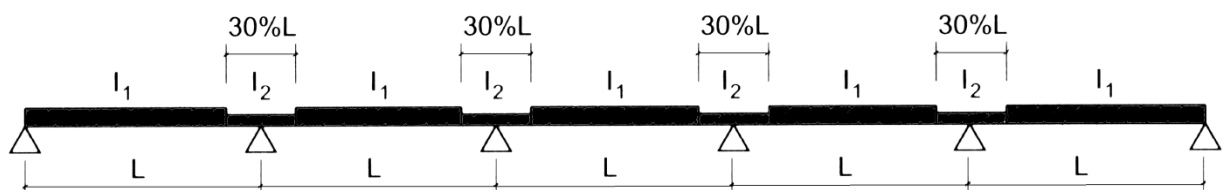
Расчетная модель балки с трещинами в железобетонной плите над опорами
